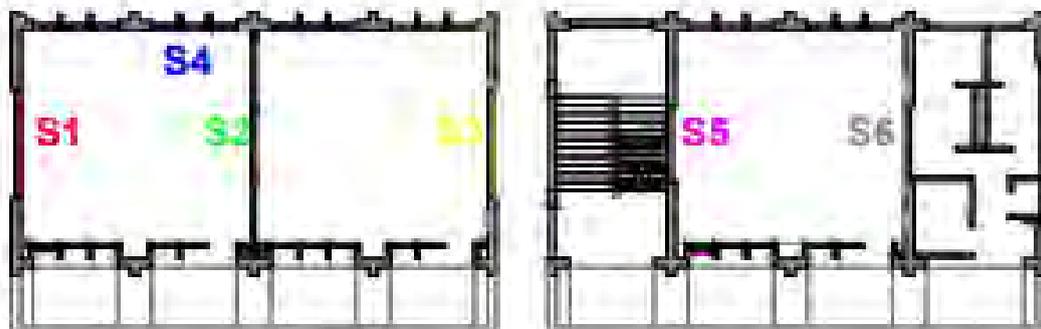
Sectorización de la actividad de asentado de muro de bloquetas 1era parte para aulas
